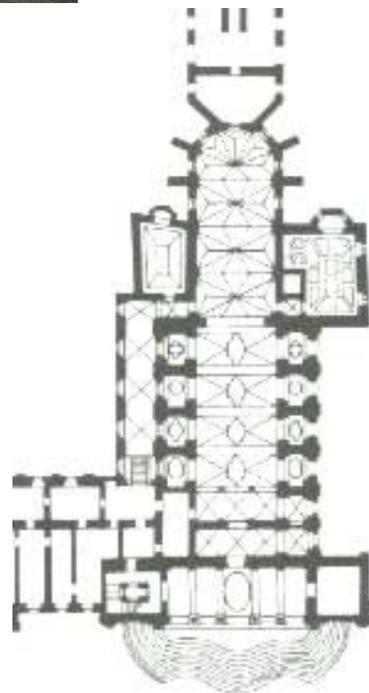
Götweig, Stiftskirche: Grundriss.
